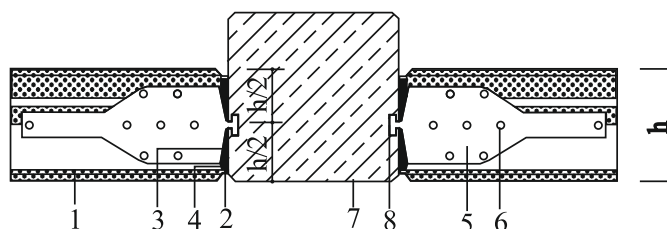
Горизонтальные сечения сопряжений внутренних и наружных стен из силикатных блоков системы SOLBET [10]
